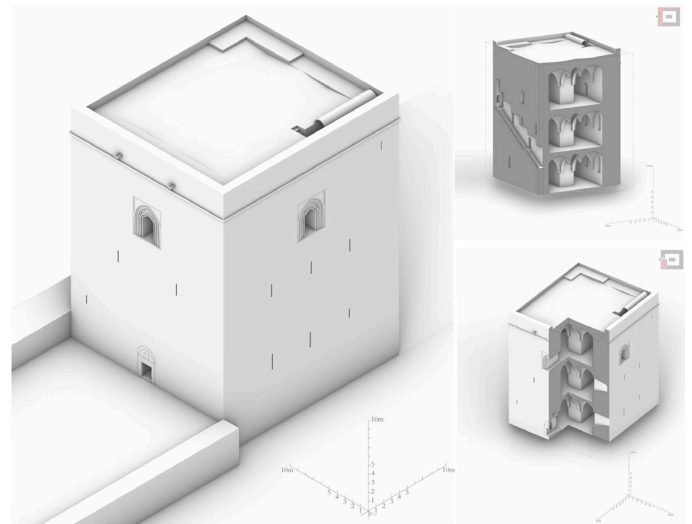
A la izquierda: volumetría exterior de las fachadas norte y este. A la derecha: volumetrías seccionadas.
